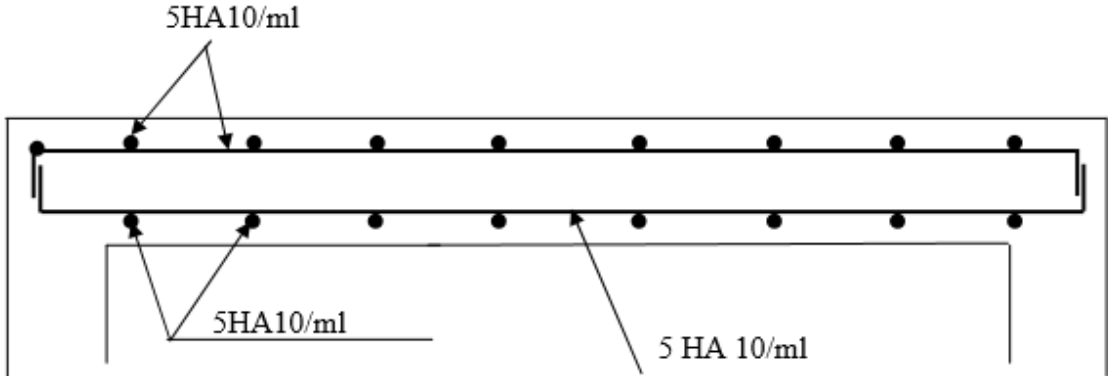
Plan de ferrailage de la dalle machine suivant y-y.
